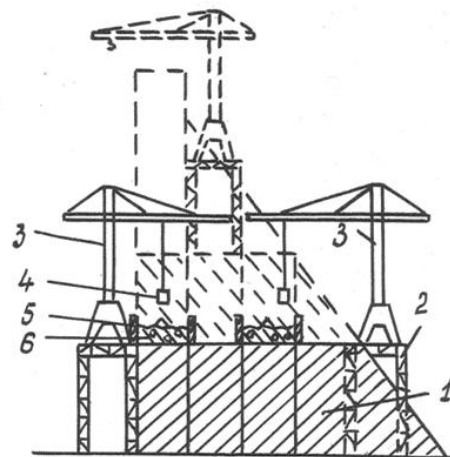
Схема возведения бетонных сооружений с размещением кранов на бетоновозных эстакадах:
